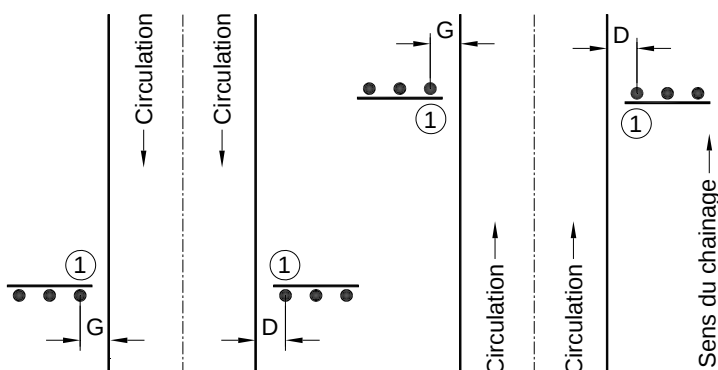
b) Dégagement latéral droit et gauche des structures de signalisation latérale sur chaussées séparées
